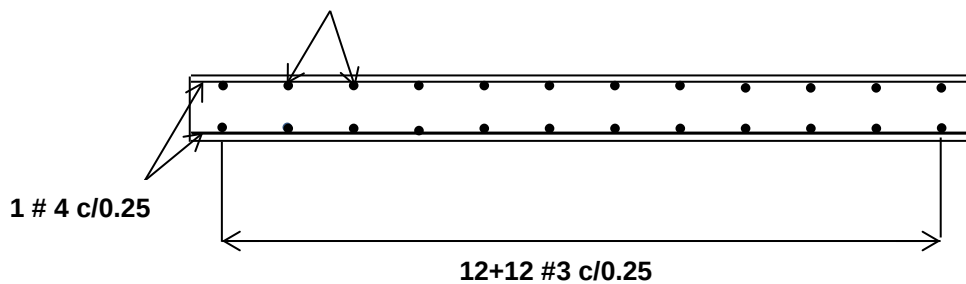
Detalle de armado de la losa de aproximación, vista longitudinal.
